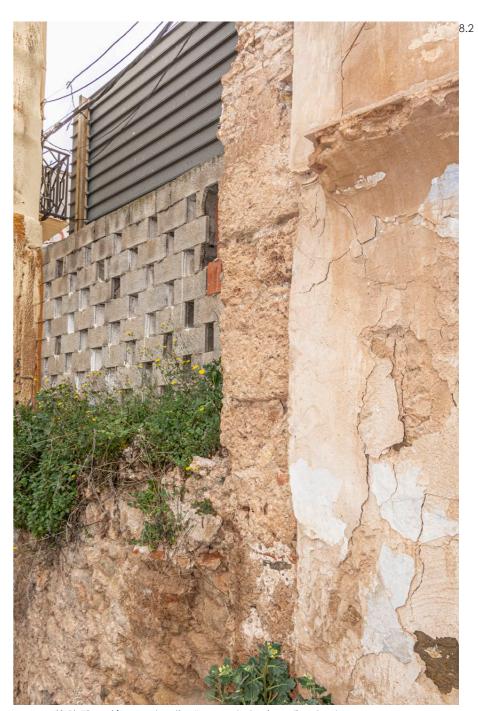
"Sección constructiva" muro de tapia calicostrada. Imagen (8.2) Refuerzo en esquina, las primeras cajas de tapia están realizadas de piedra, las cajas superiores son reforzadas con ladrillo.
